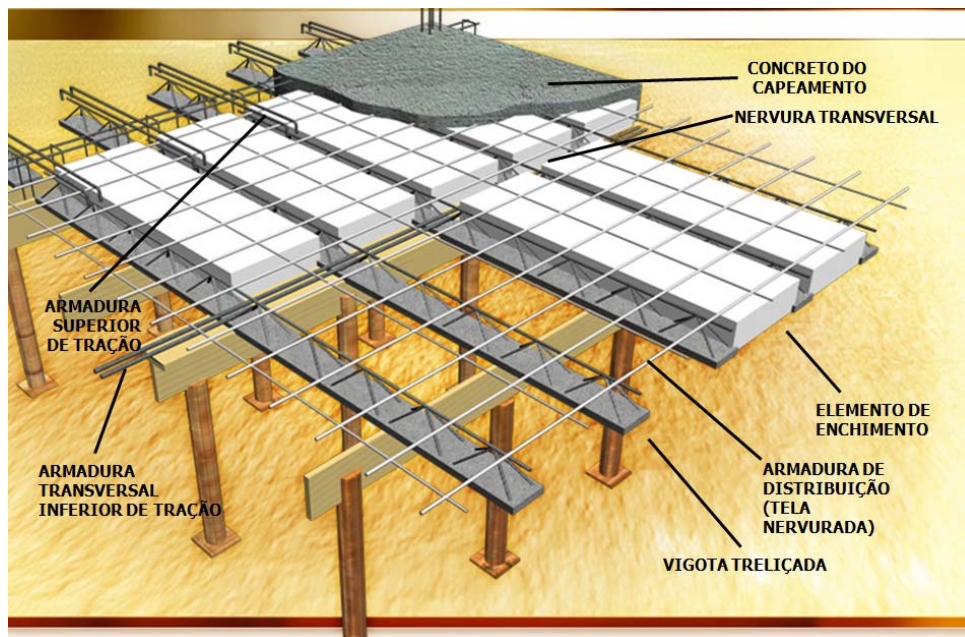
Detalhe da laje nervurada trelçada unidirecional
